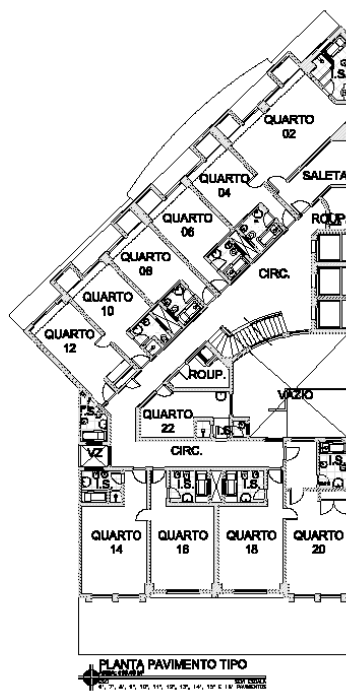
PLANTA 6º AO 16º PAVIMENTO – HOTEL NORMANDY – ELABORADO PELA AUTORA – 09/2011.
